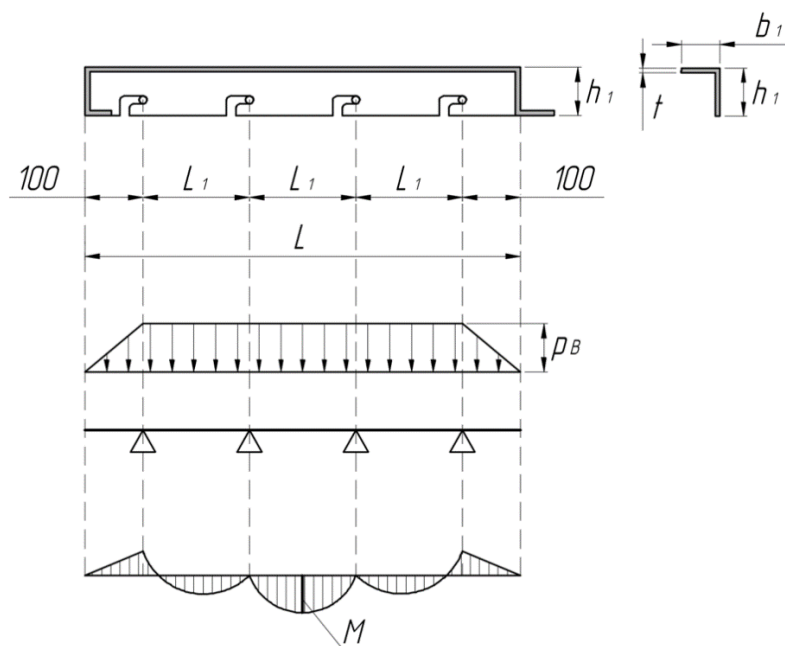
Расчётная схема вертикального ребра панели (однопролетные балки).
